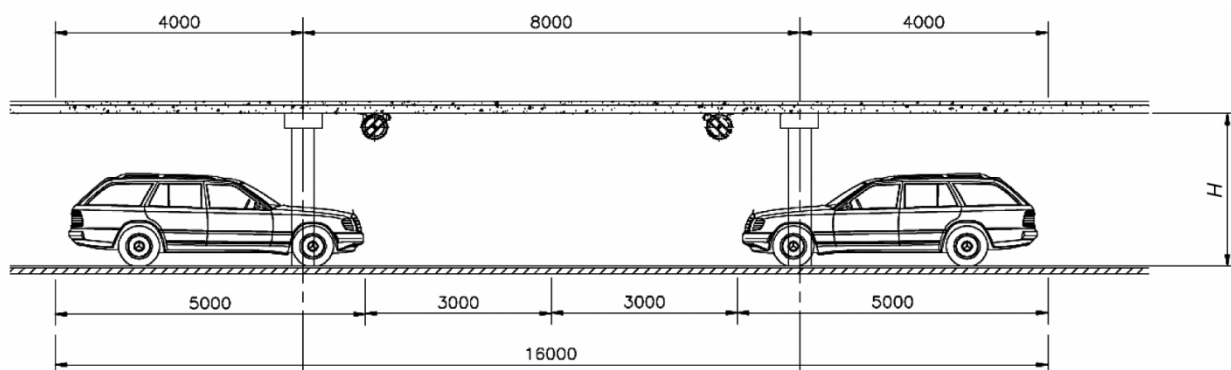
Расположение струйных вентиляторов над дорожным полотном, рядом с колоннами
